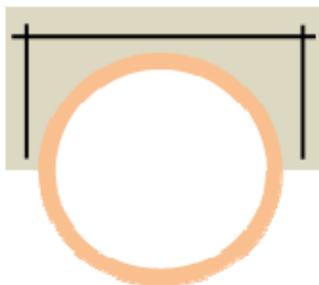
Protection d'une canalisation par une voûte en béton armé
